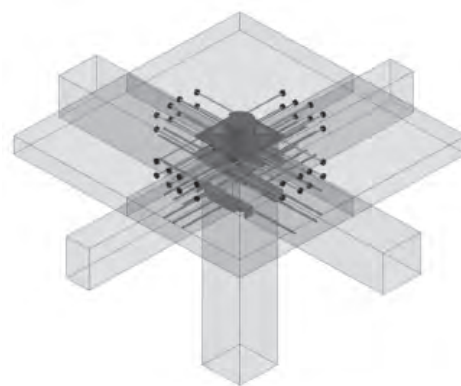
Стык железобетонных строительных элементов в собранном виде
